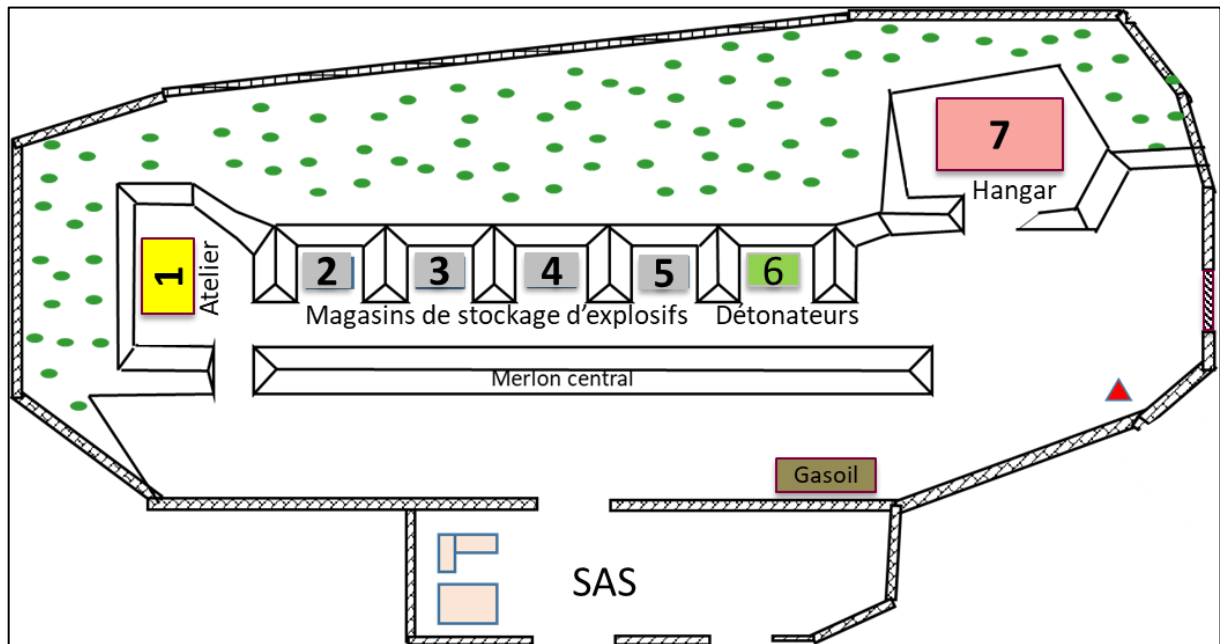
ETAT PROJETE DU SITE APRES TRAVAUX.
